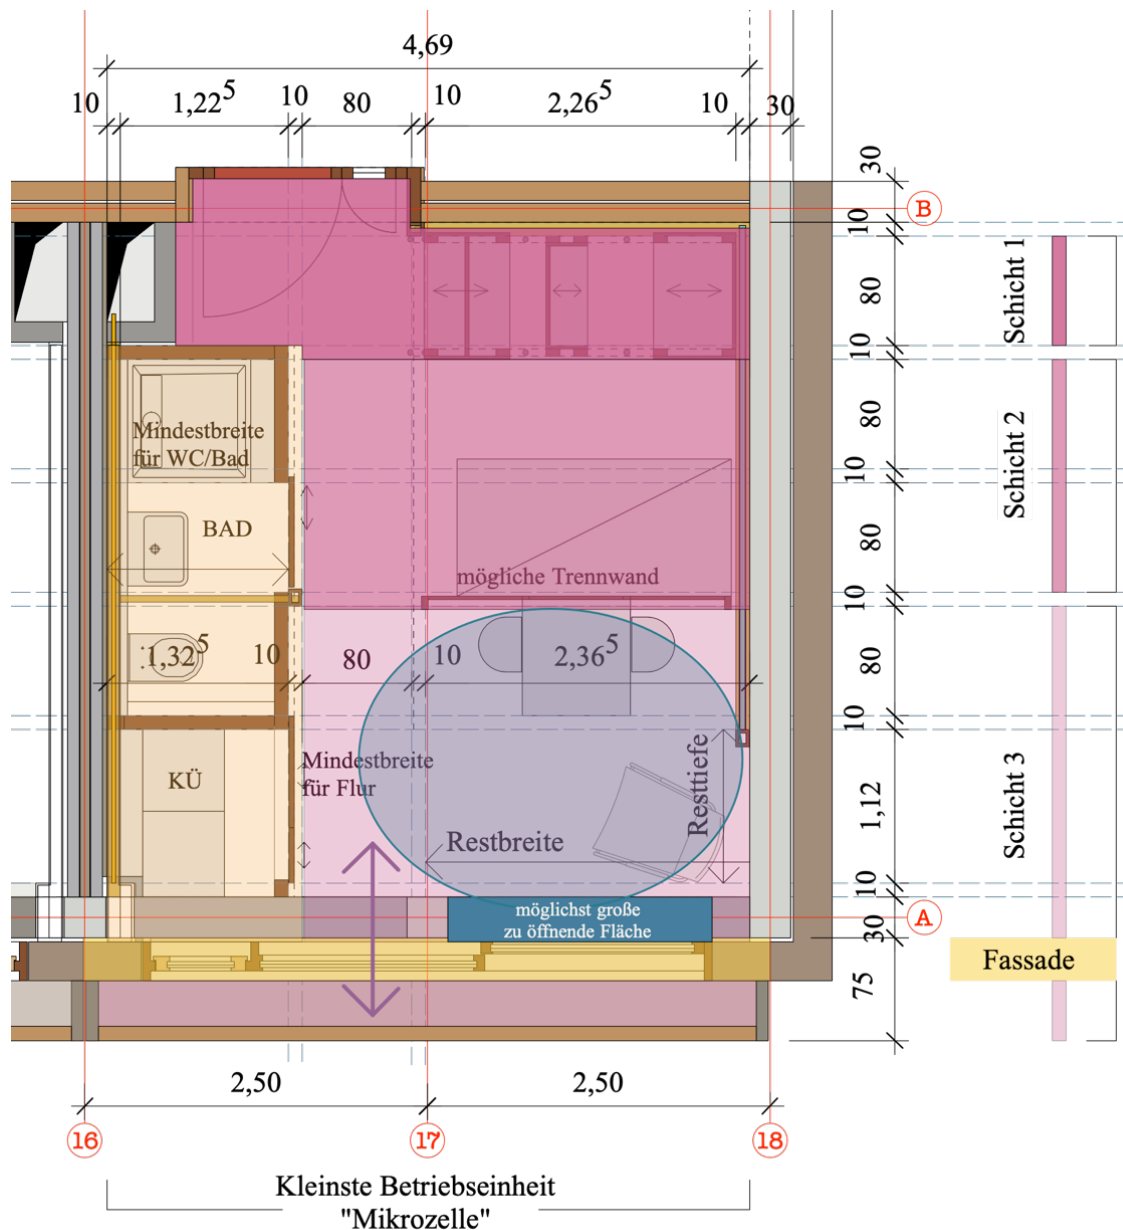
Darstellung Grundriss - Raumschichten
